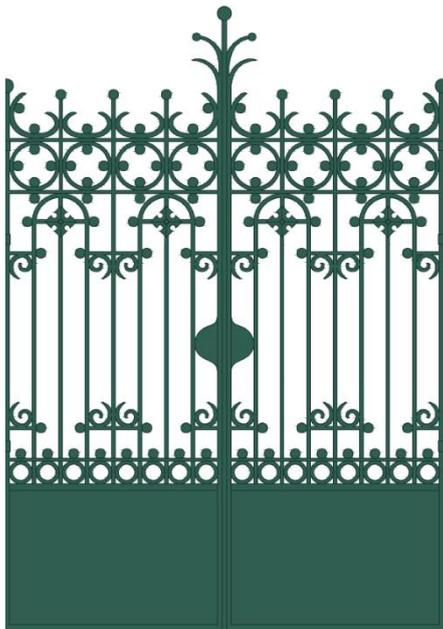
Levantamiento en CAD puerta acceso a la parcela. 2015. Fuente propia.
